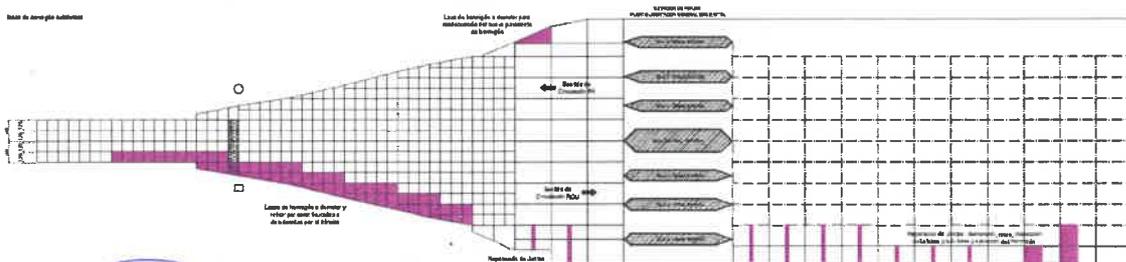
Vista en planta de las losas a demoler y reparación de juntas.
